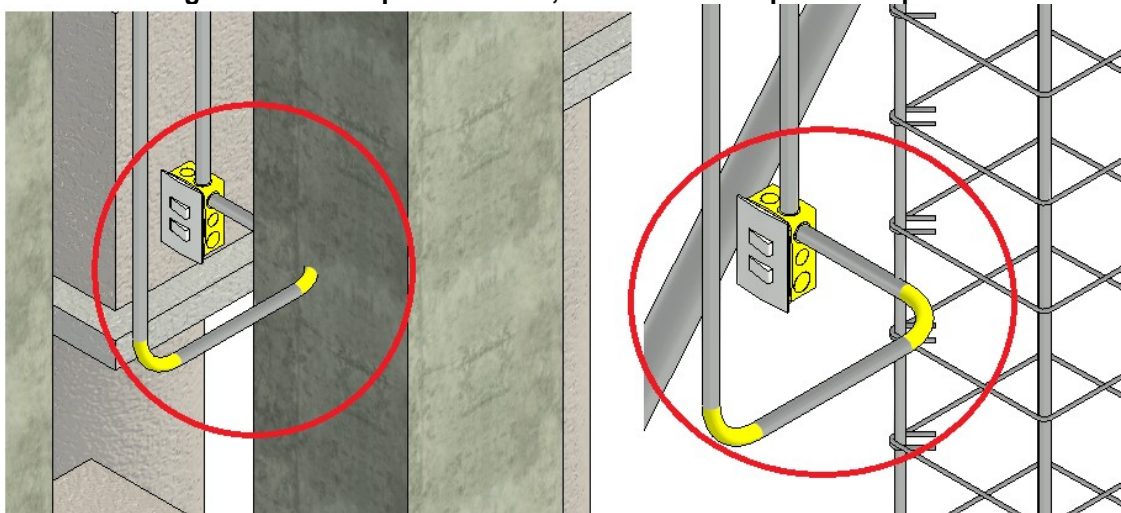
Incompatibilidade 4, eletroduto transpassando pilar.
